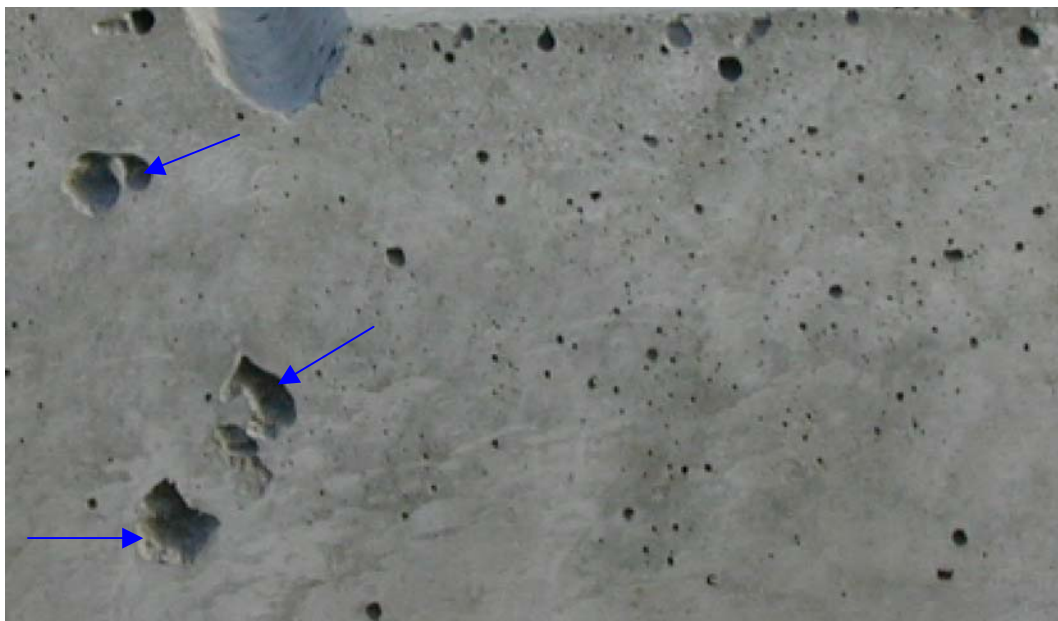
vereinzelt größere Poren an der Betonoberfläche, Betonqualität nicht beeinträchtigt, Schadenklasse 4
